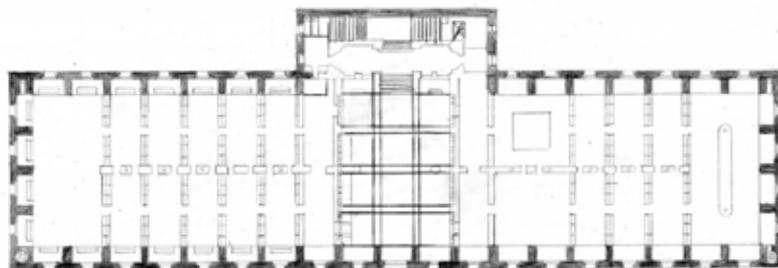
Grundriss des Magazinraumes im Erdgeschoss der Bibliothèque Sainte-Geneviève
